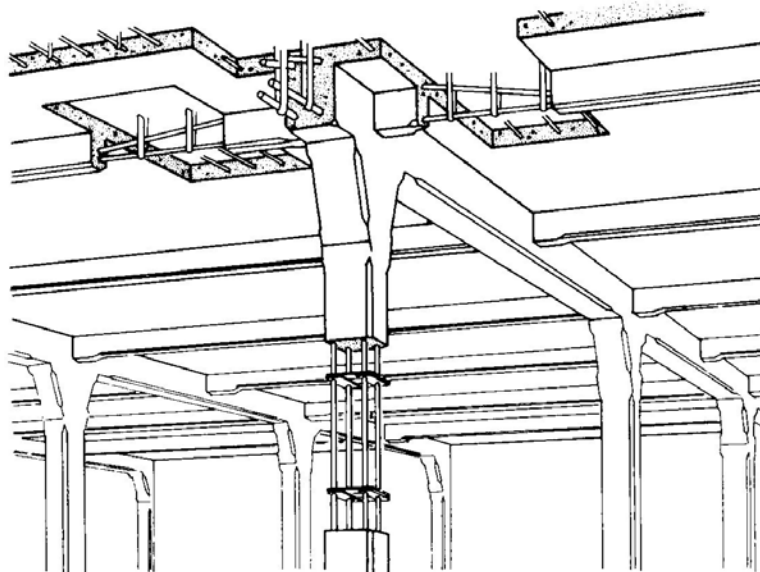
Système Hennebique pour la construction de dalles en béton armé, 1892, ing. F. Hennebique
